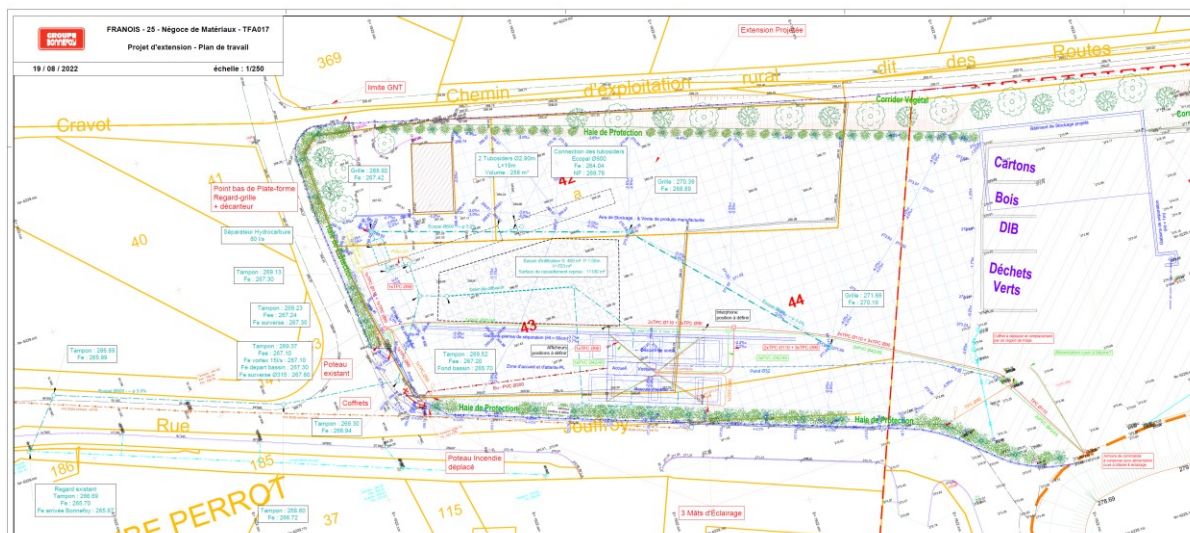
Plan de masse du projet (source : Maître d'Ouvrage)
